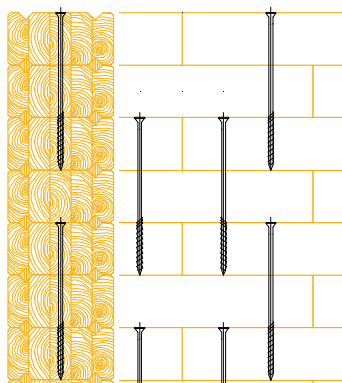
Corte longitudinal e transversal de um pano de parede de alvenaria estrutural em madeira.
